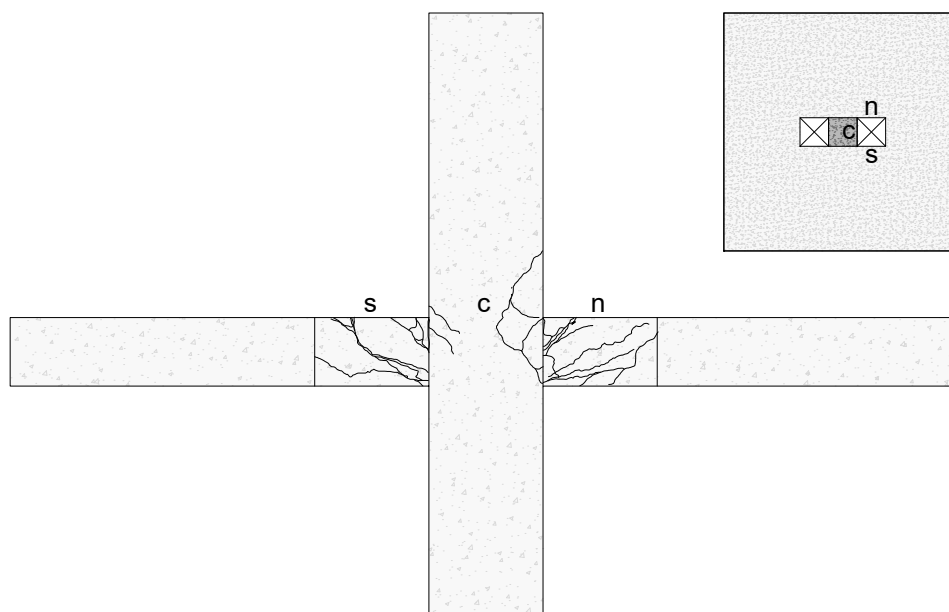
Padrão de fissuração da laje LFE1 - vistas abertura
